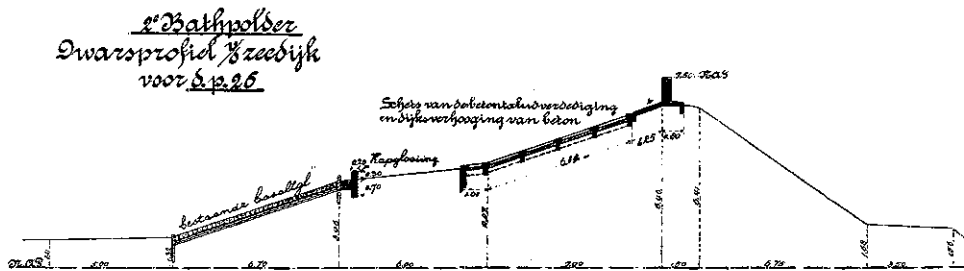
Dijkverhoging van gewapend beton met aansluitende bepantsering van het buitentalud eveneens met gewapend beton en kapglooing van gewapend beton
